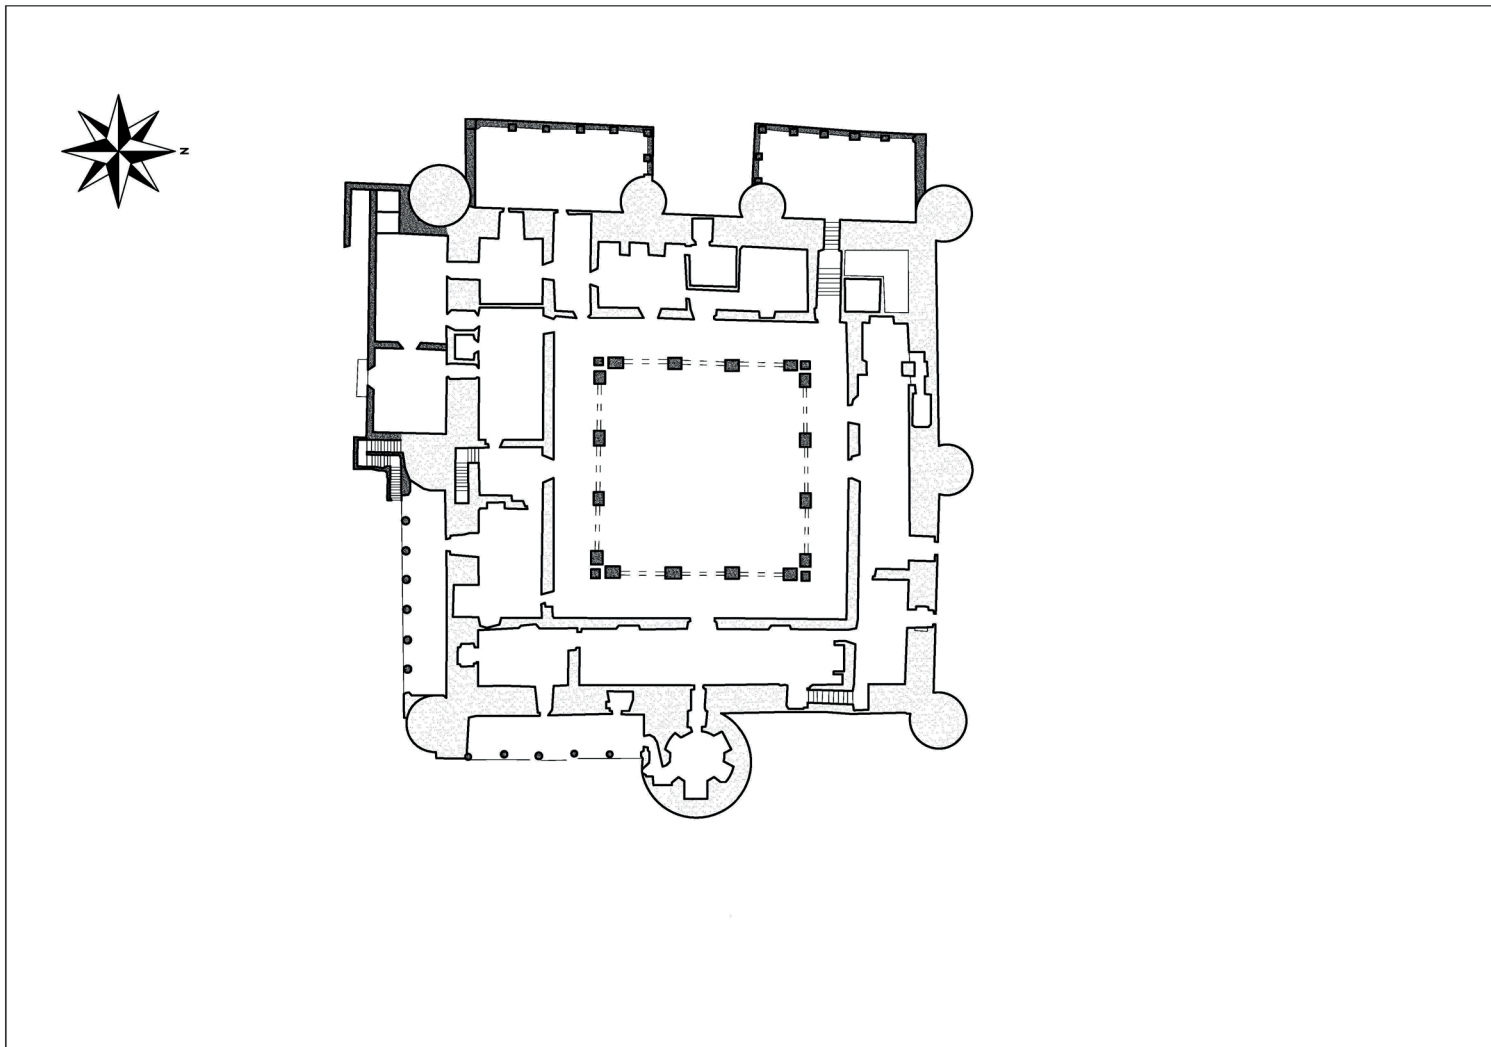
PLANO DEL ALCÁZAR DE ZAFRA, PLANTA PRINCIPAL
